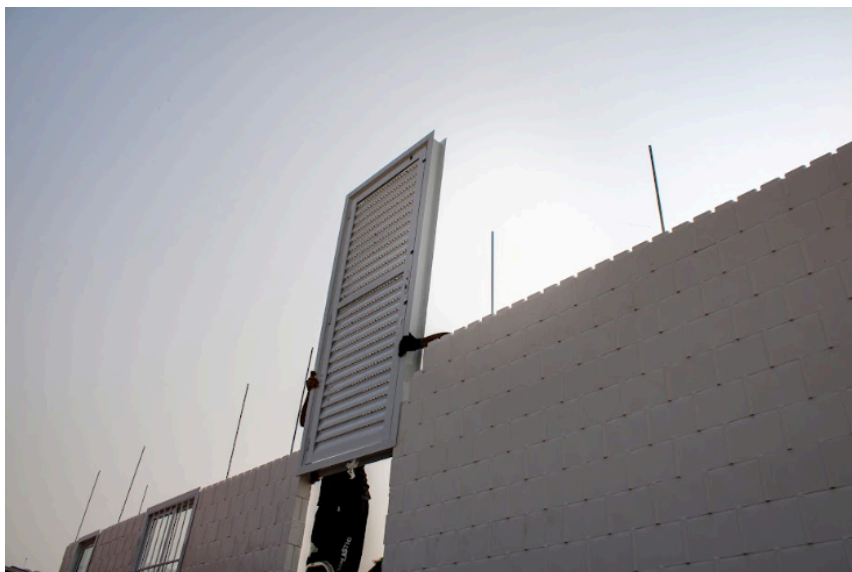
Instalação de janelas e corte na “cabeça” do bloco
